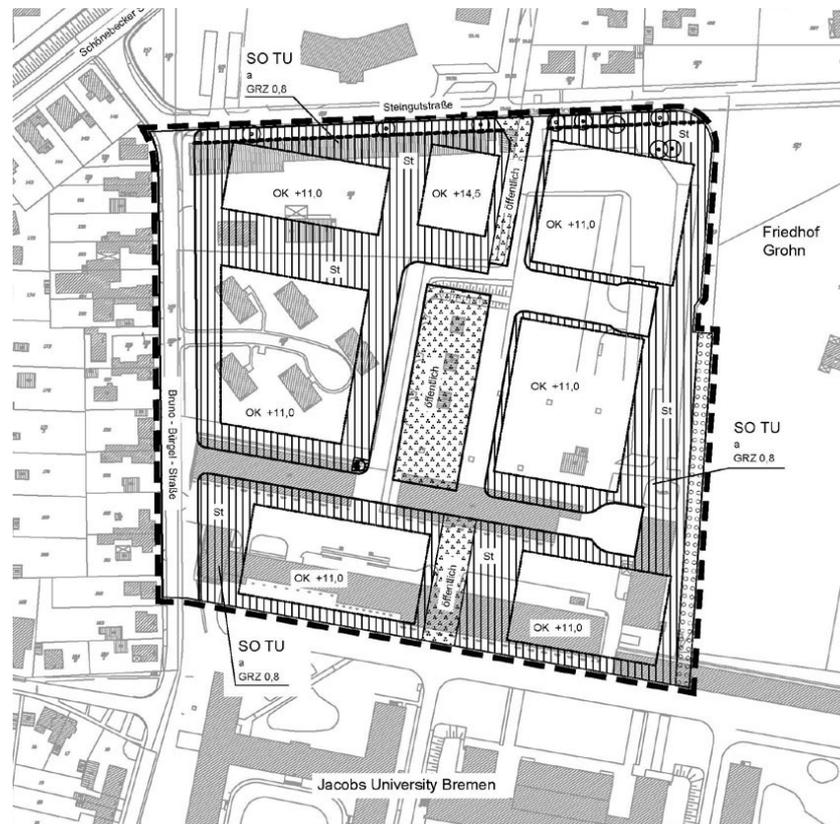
Geltendes Planungsrecht Bebauungsplan 1299
